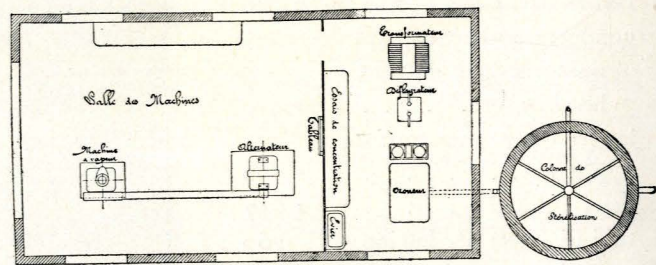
Pianta dello Stabilimento di ozonizzazione di Emmerin (Lilla).
